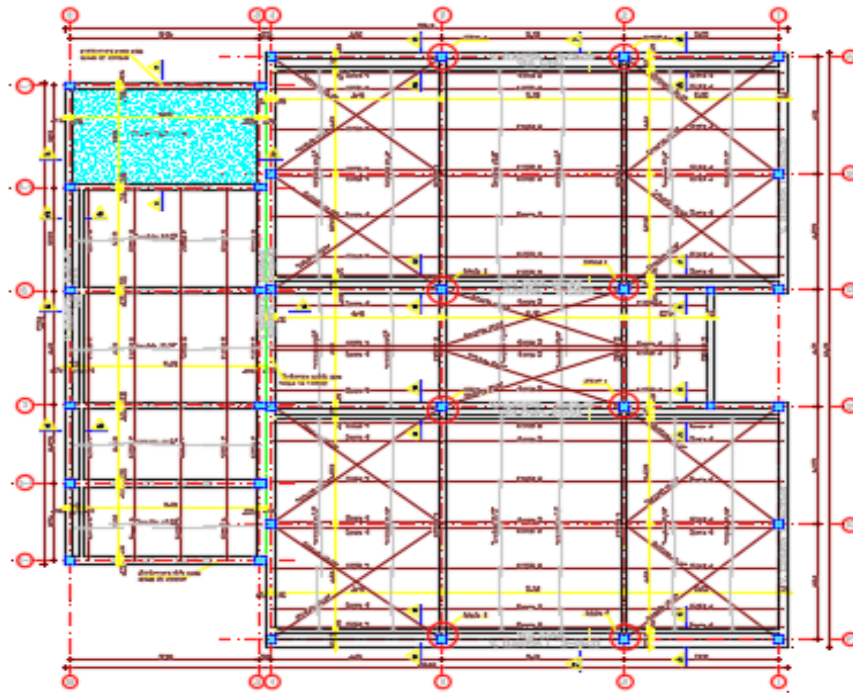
Esquema general en planta de cubierta actual nivel +3.94 m. Fuente: Propia
